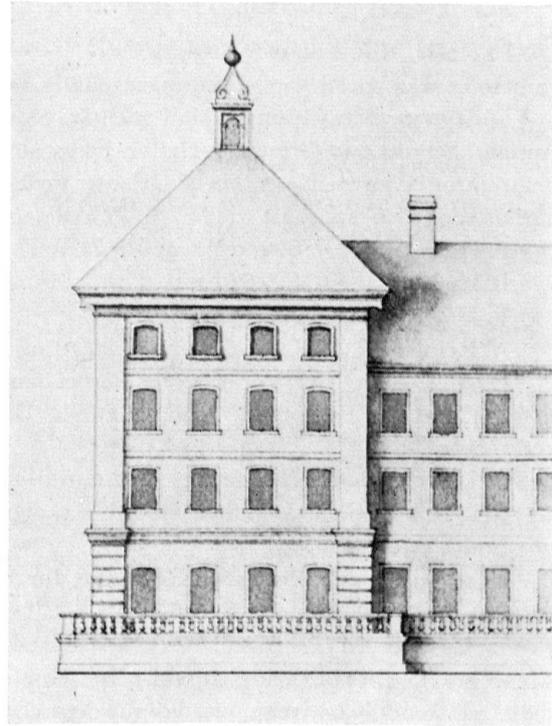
Lindau, Damenstift. Entwurf J. M. Beers, 1729. Stiftsgebäude (Detail) (BHStA München, Plslg. Nr. 11, 393)
